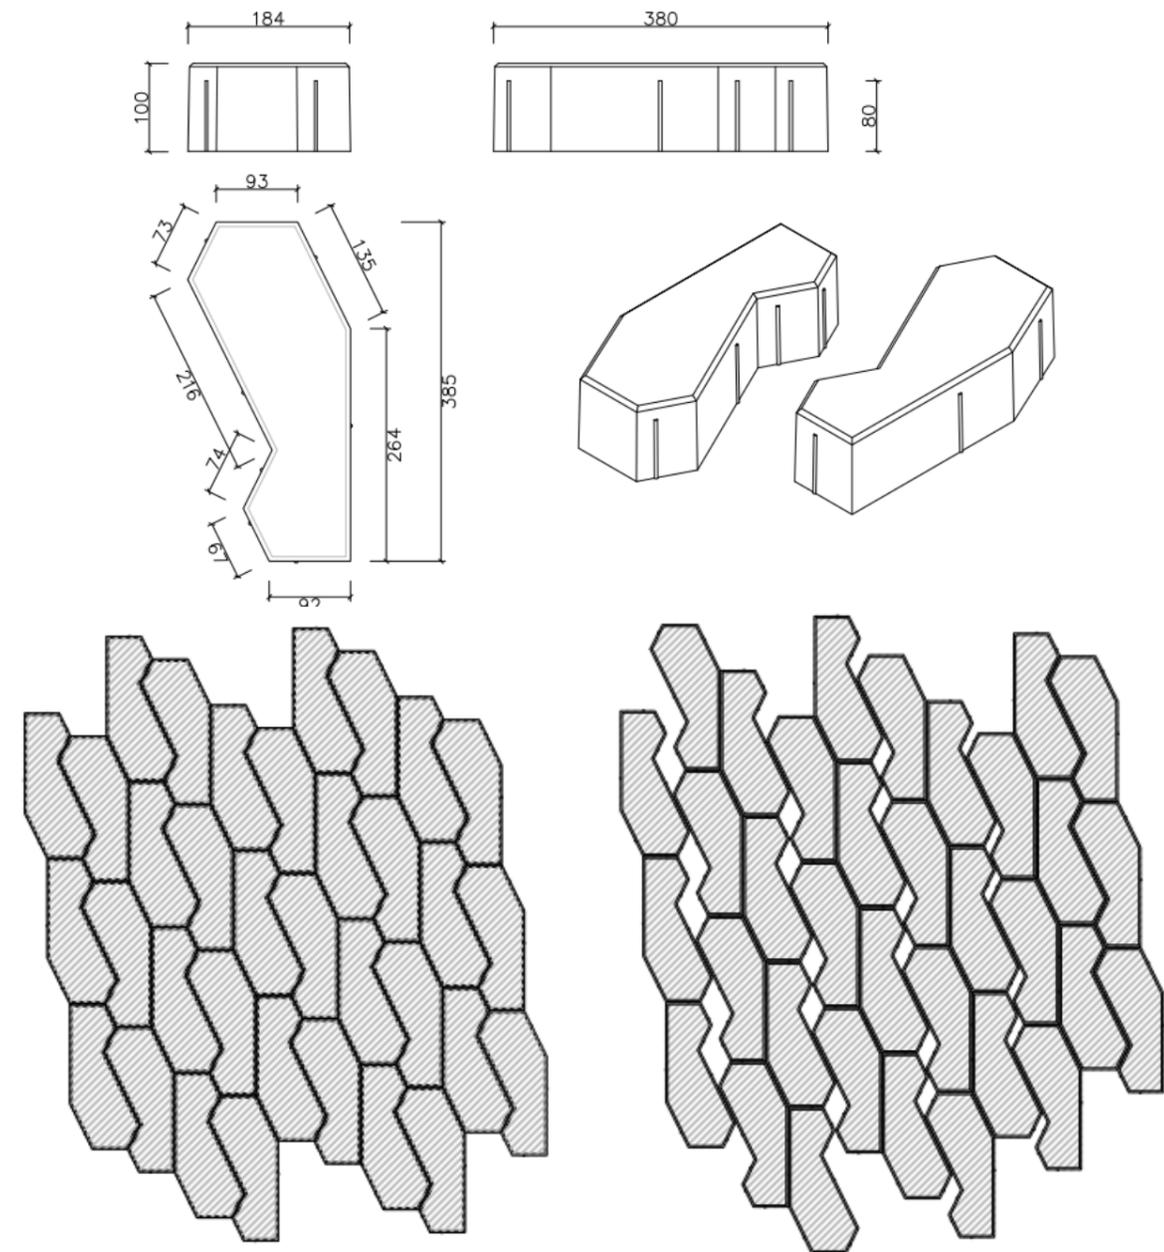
Dimensiones pavimento "huella". Fuente: Escofet.com
